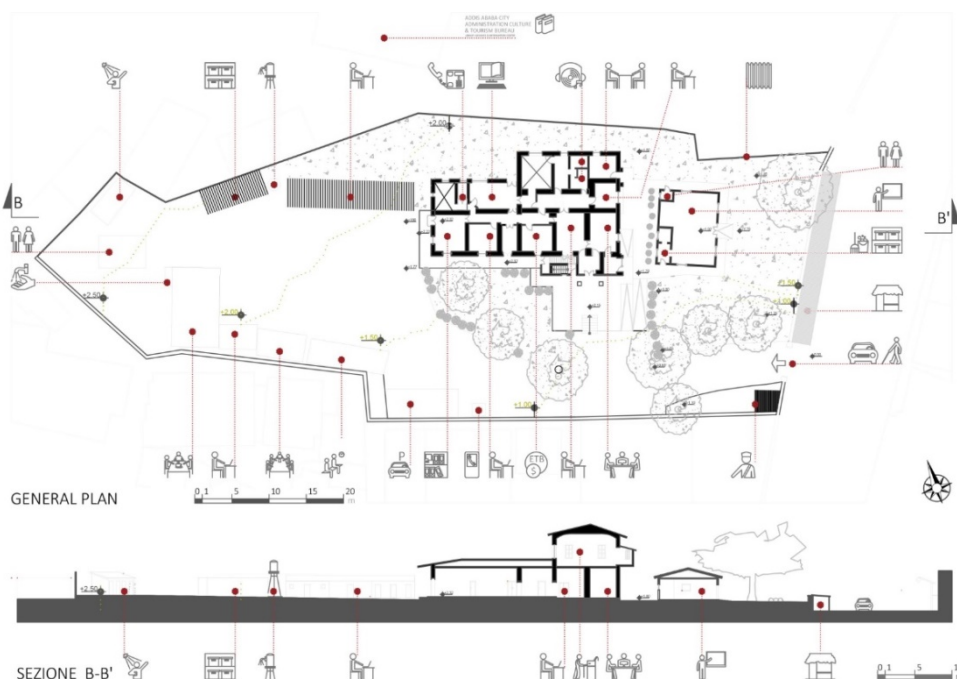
, ENAB: Stato Attuale, planimetria e sezione longitudinale
